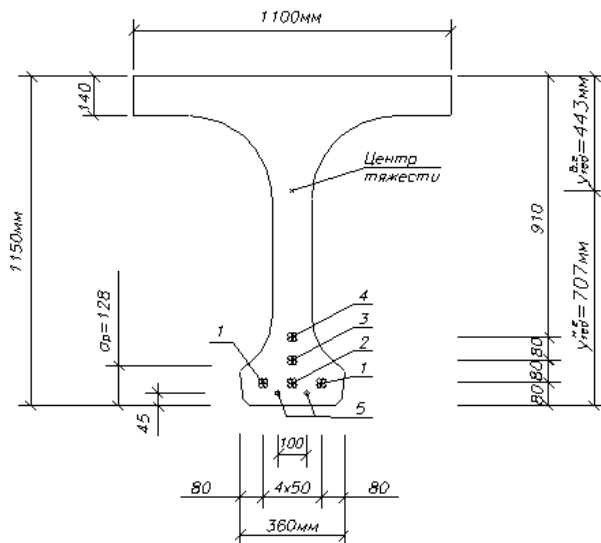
Поперечное сечение балки ВТК-24У в середине пролета без накладной плиты и швов омоноличивания:
